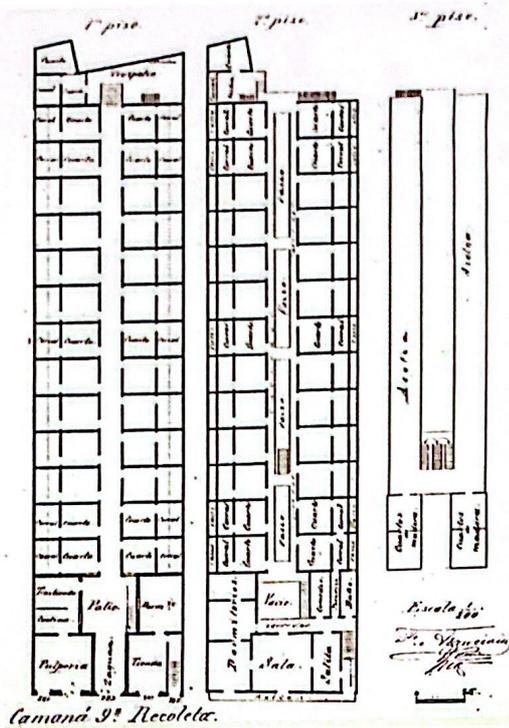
Planta de Casa en Jr. Camaná Cdra. 9.
